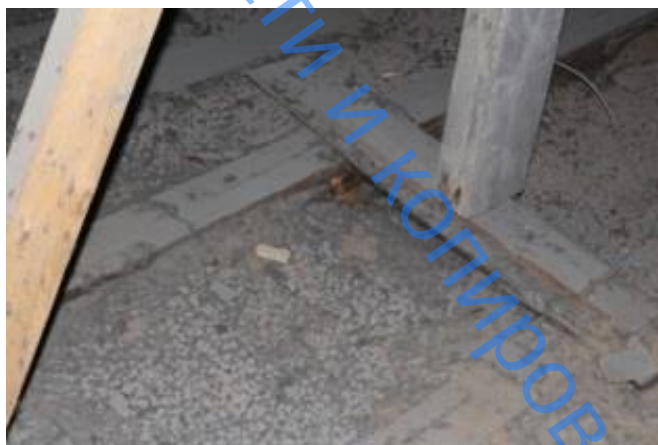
Контрольная врубка балок перекрытия второго этажа. Глубокое поражение гнилью в осях 2-8/Г-Ж
